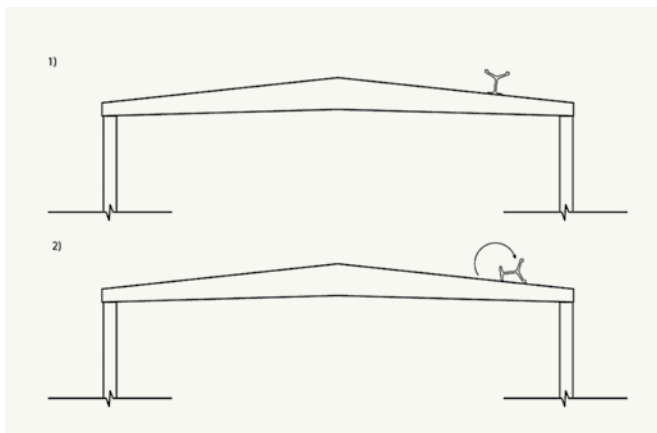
Esquema de volcamiento de viga secundaria tipo Tau.
